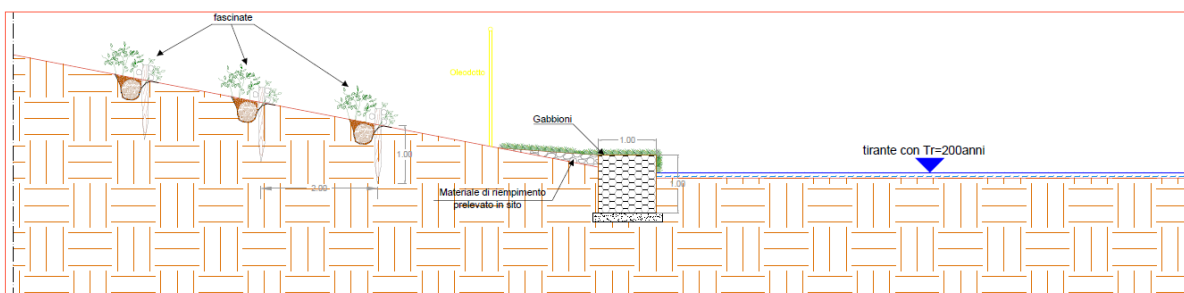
Particolare sezione 3.1\_Punto 01.434
